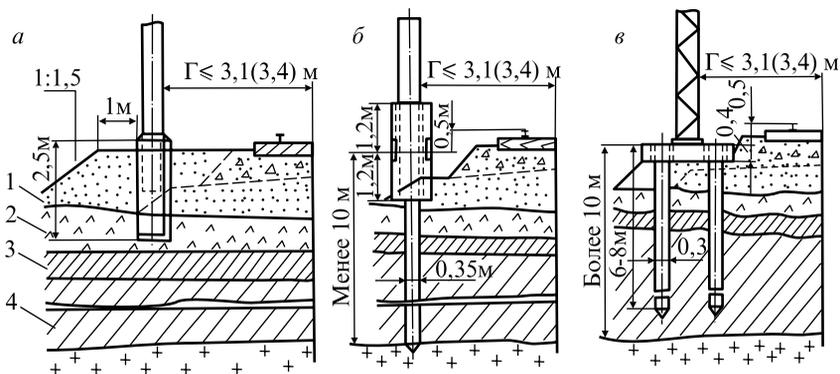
Способы закрепления опор контактной сети в слабых грунтах: *а* — блочный фундамент с уширенной полкой; *б* — свая-стойка со сборным стаканым оголовком; *в* — двухсвайный фундамент с ростверком и висячими сваями; 1 — присыпка; 2 — торф; 3 — корка; 4 — глина
